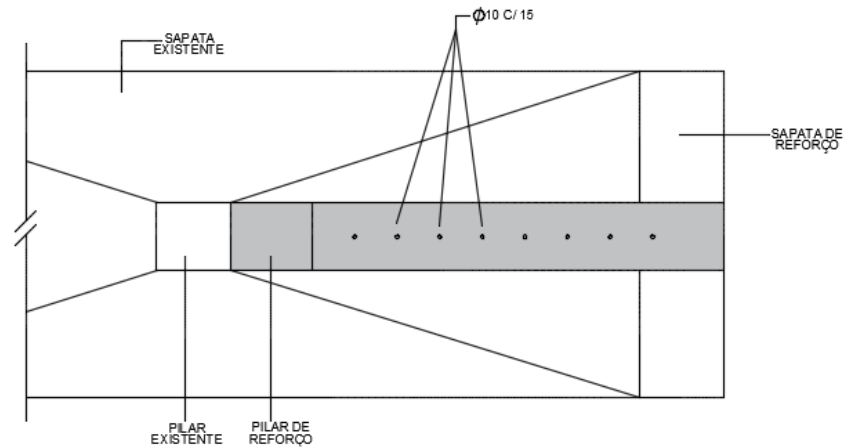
Vista em corte da viga de equilíbrio e a sapata (cm)
